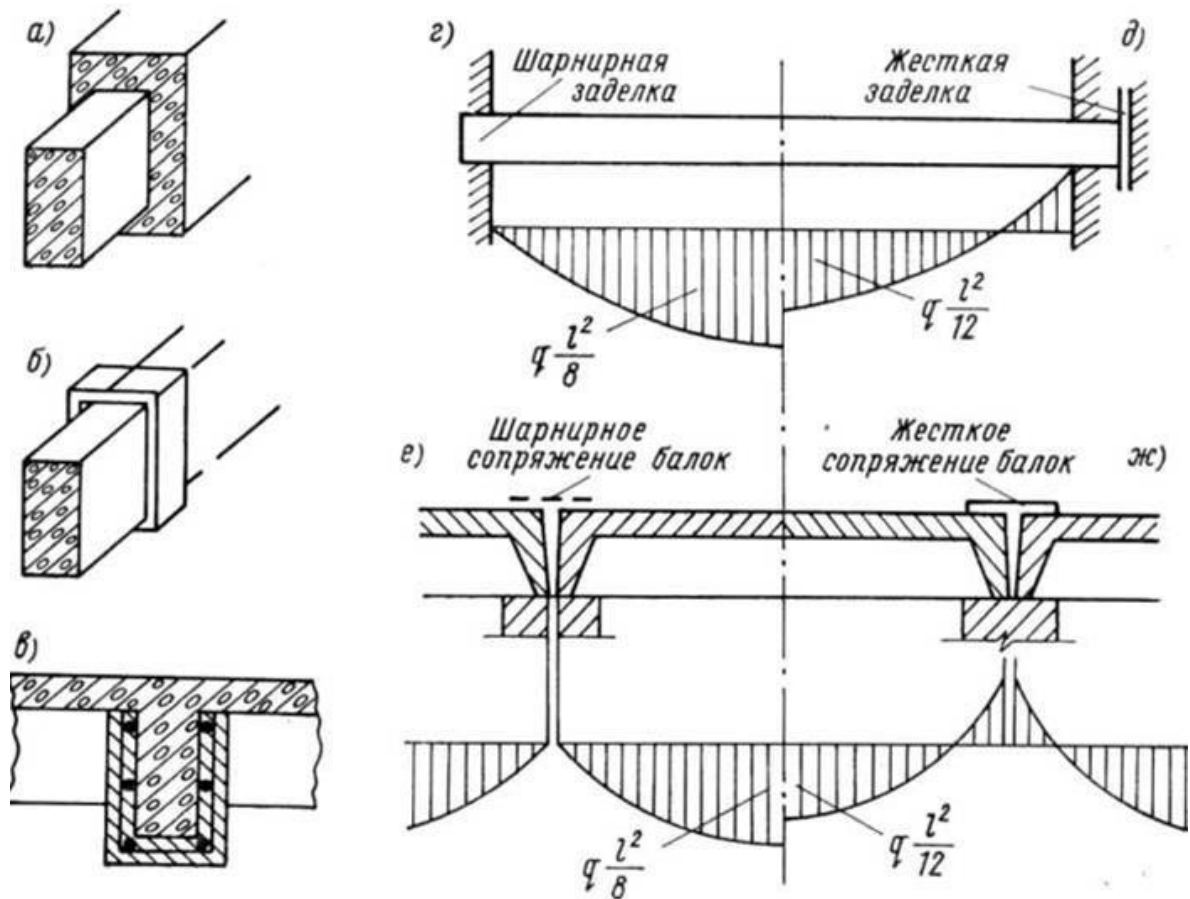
Способи підсилення залізобетонних балок: а, в - обетоннуванням; б - хомутами; г, д, е, ж - з'єднанням на опорах
